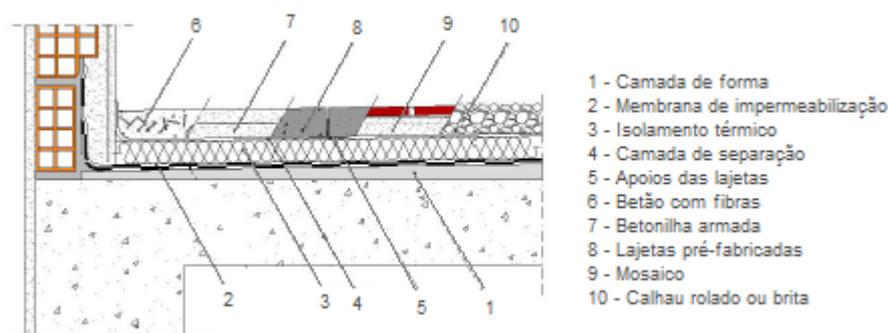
Impermeabilização de cobertura plana acessível à circulação de pessoas (Aspim@ 2013)
